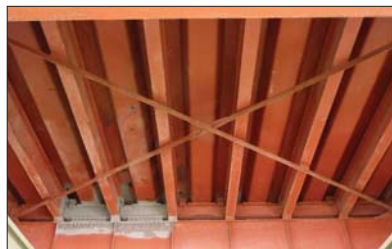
| Widok kratowej belki usztywniającej przęsła głównego. Widok wózków rewizyjnych podwieszonych do jej konstrukcji
